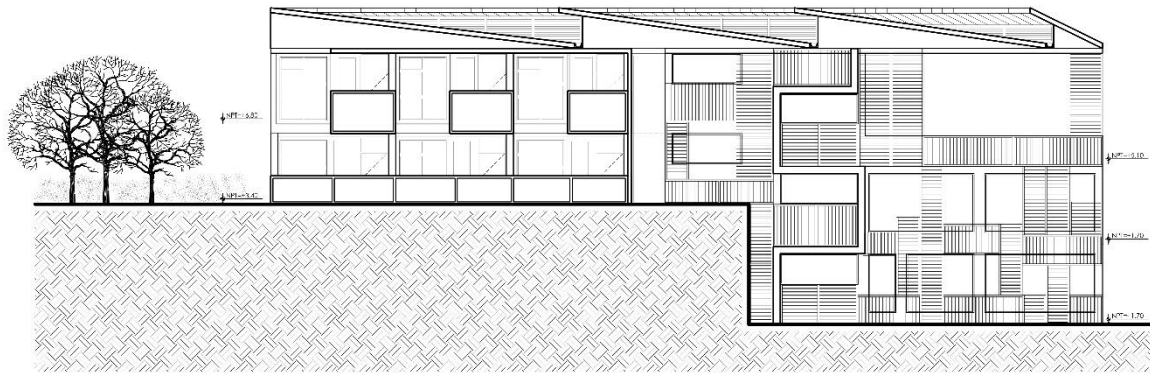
Fachada lateral derecha Jardín Infantil
